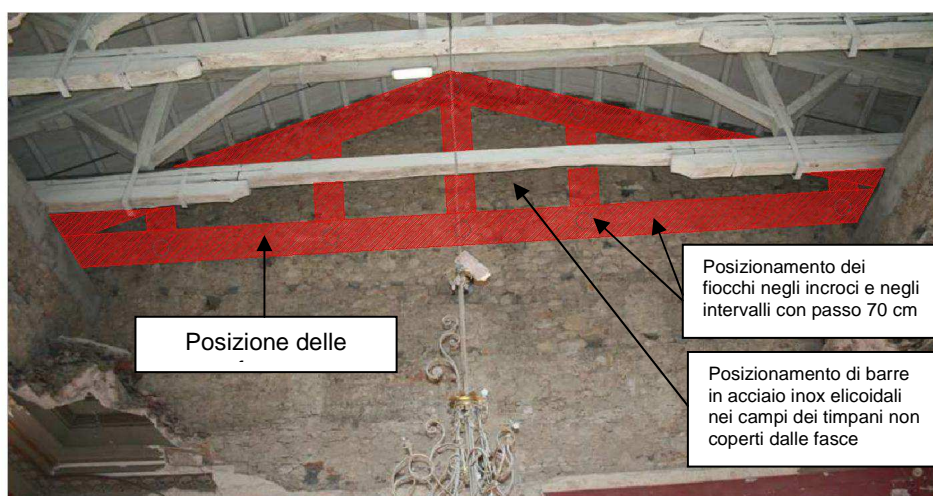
Individuazione della posizione di fasce ed ancoraggi (controfacciata)
